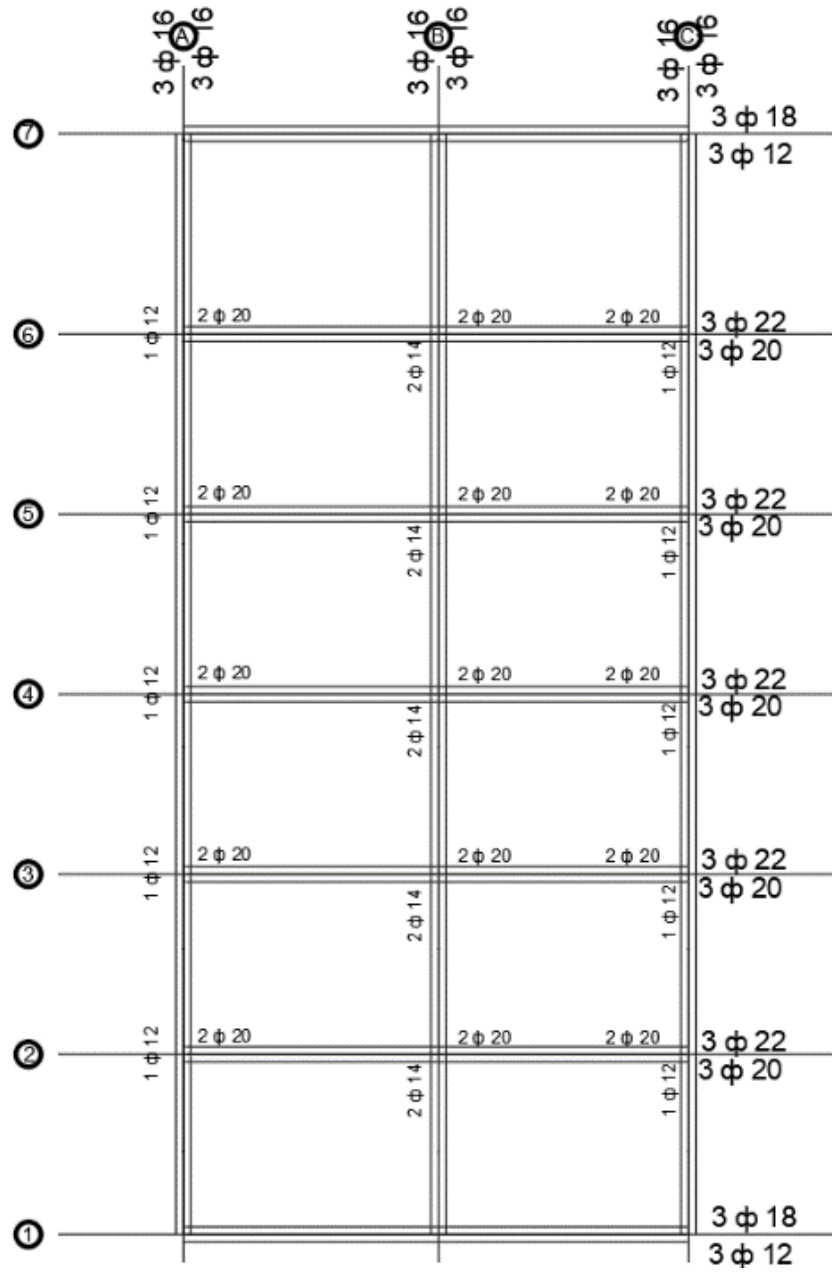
Esquema de Armado primer piso; Fuente: Autoría Propia
